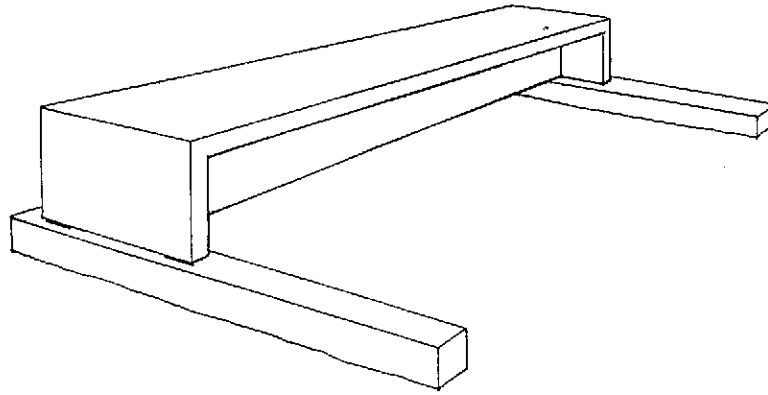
Viga de hormigón, con las típicas culatas extremas de apoyo.
